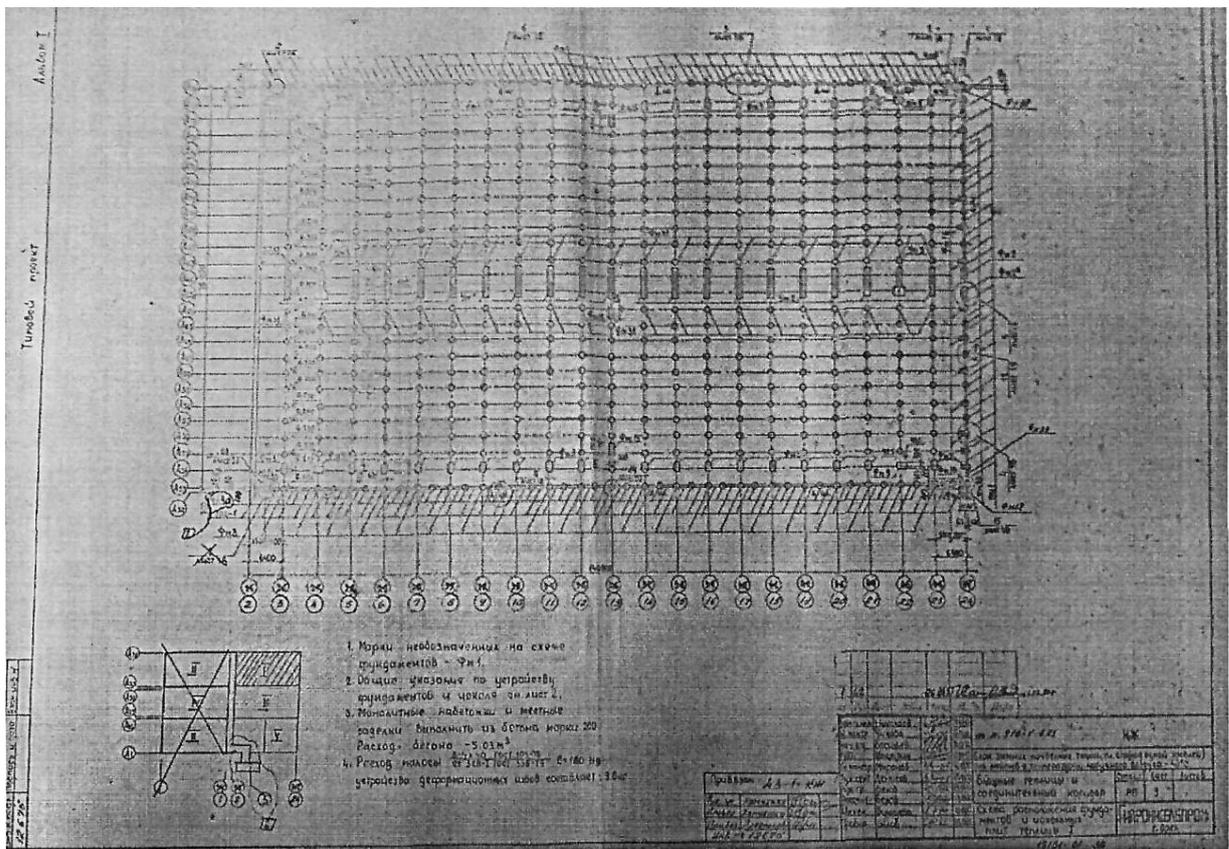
Схема расположения фундаментов и цокольных плит теплицы
